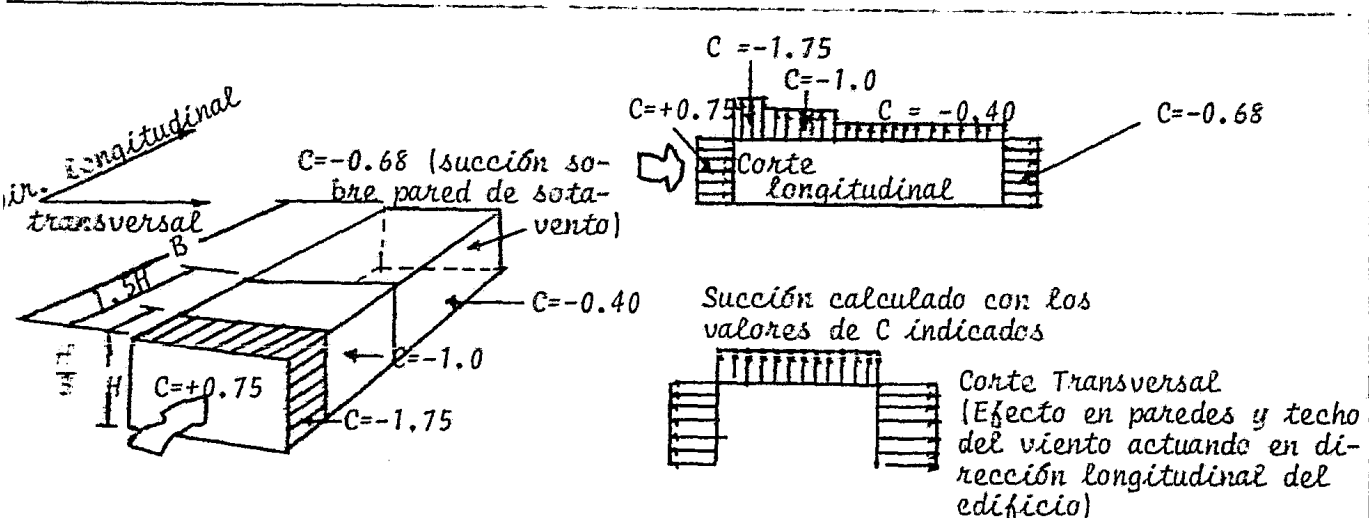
Distribución del coeficiente de empuje. Edificios de planta y elevación rectangulares.
